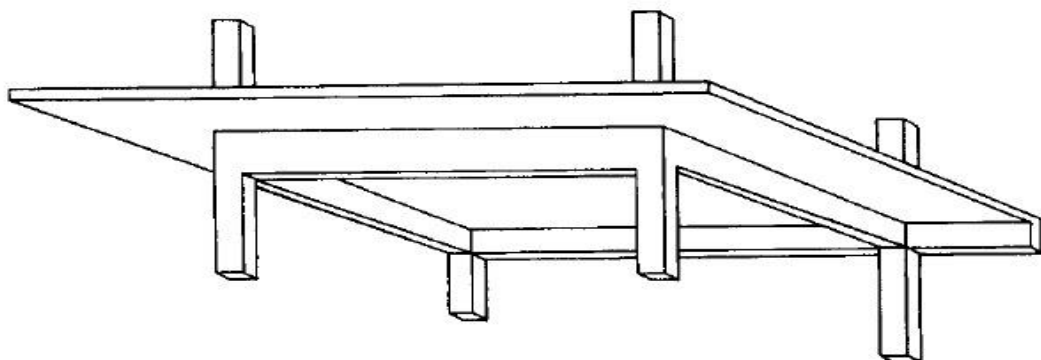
Penerapan Pelat Lantai Dengan *Drop Panel
